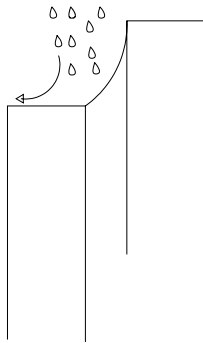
Esquema del flashing entre juntas constructivas.
